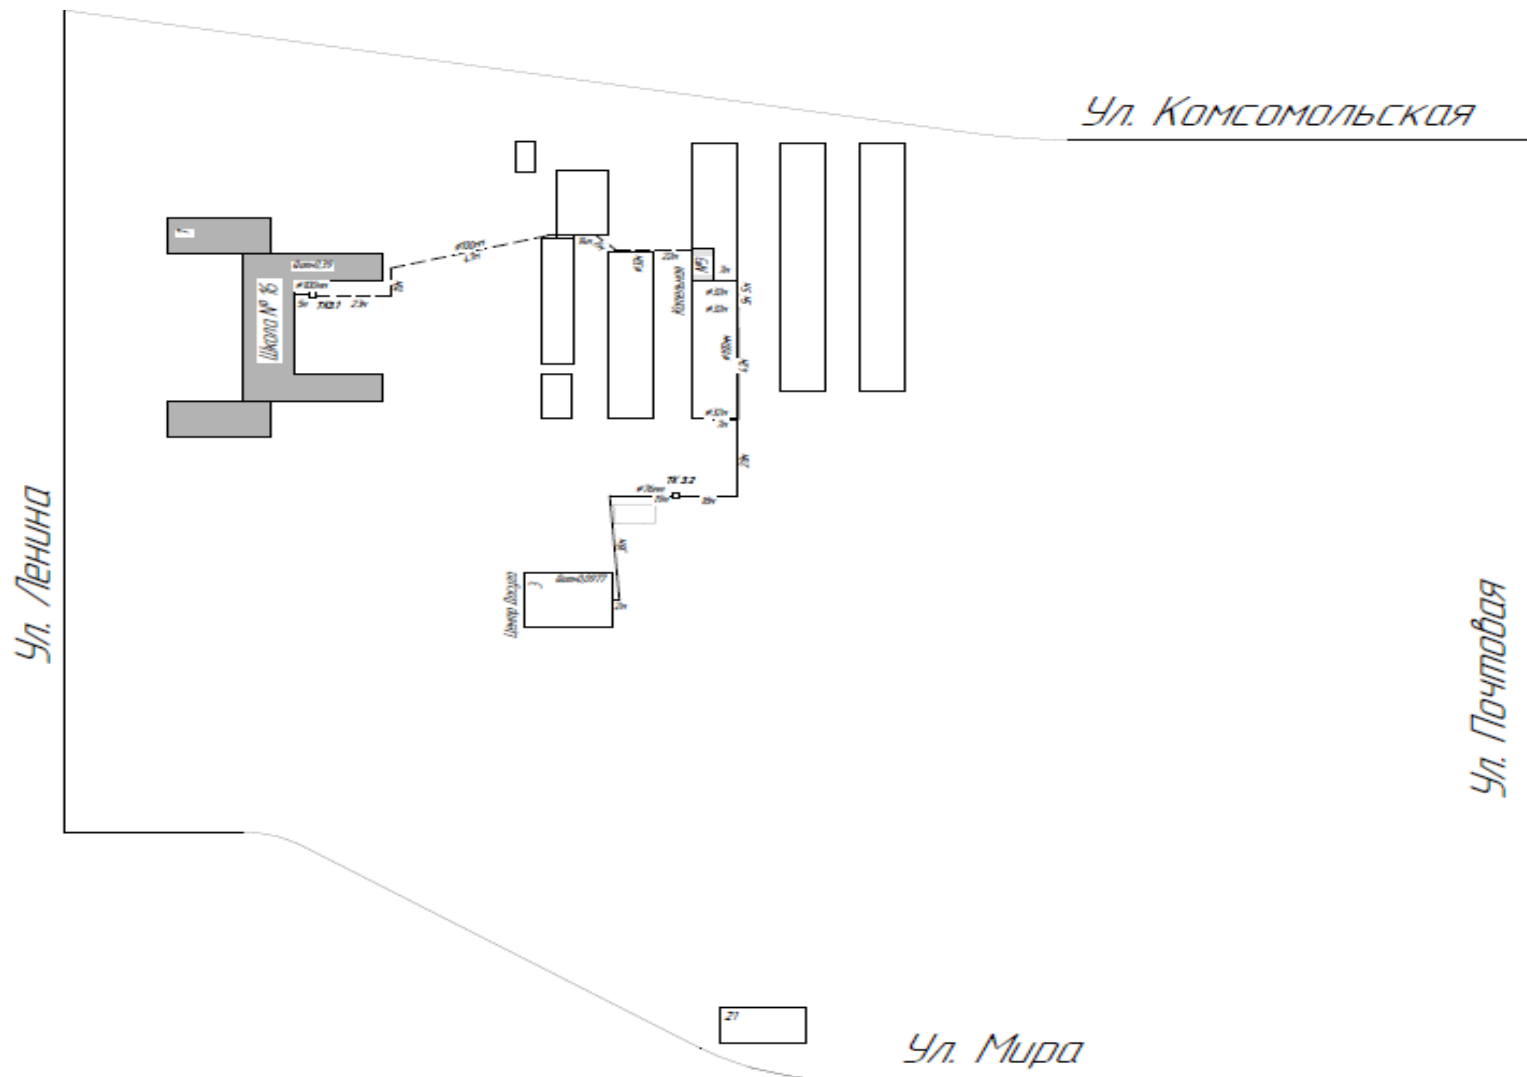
Схема тепловых сетей от котельной №3
